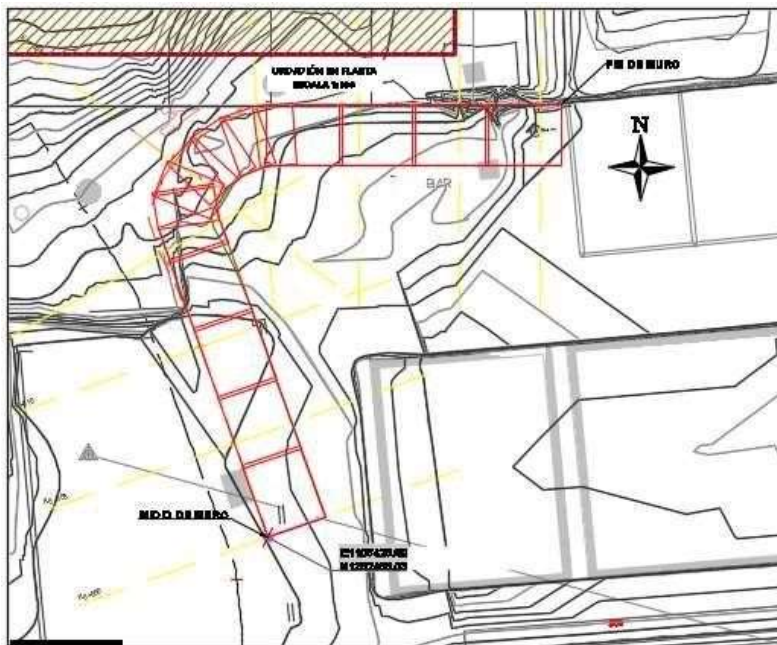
Ubicación del muro en planta - MSE Tiburones
